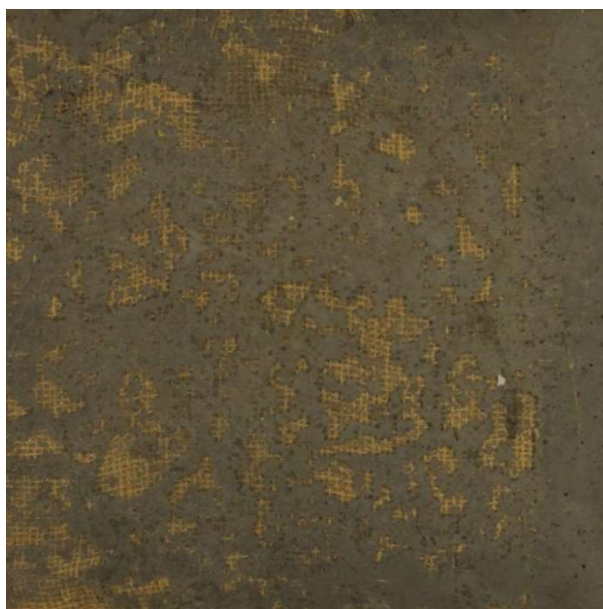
Betonový povrch s jutovou vložkou pro Recepturu II
